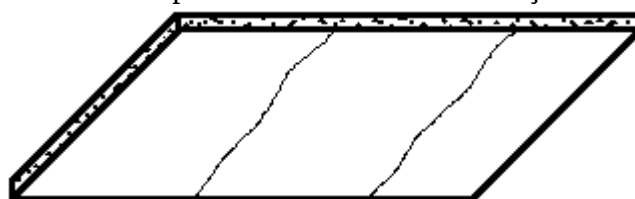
Fissura de cisalhamento causada por expansão térmica da laje
